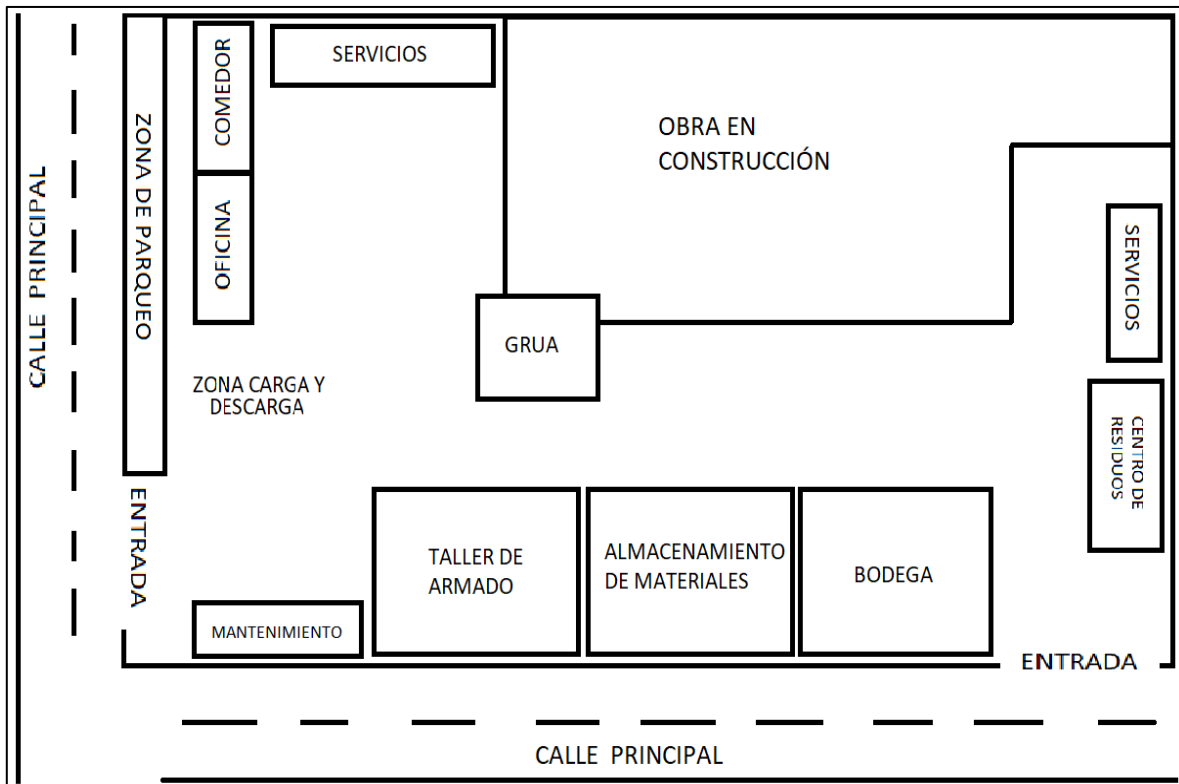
Ejemplo Diseño de sitio proyecto constructivo
